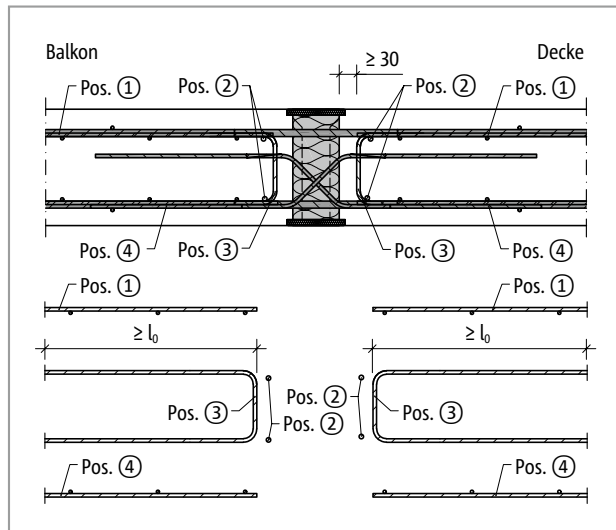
Schöck Isokorb® T Typ D: Bauseitige Bewehrung
